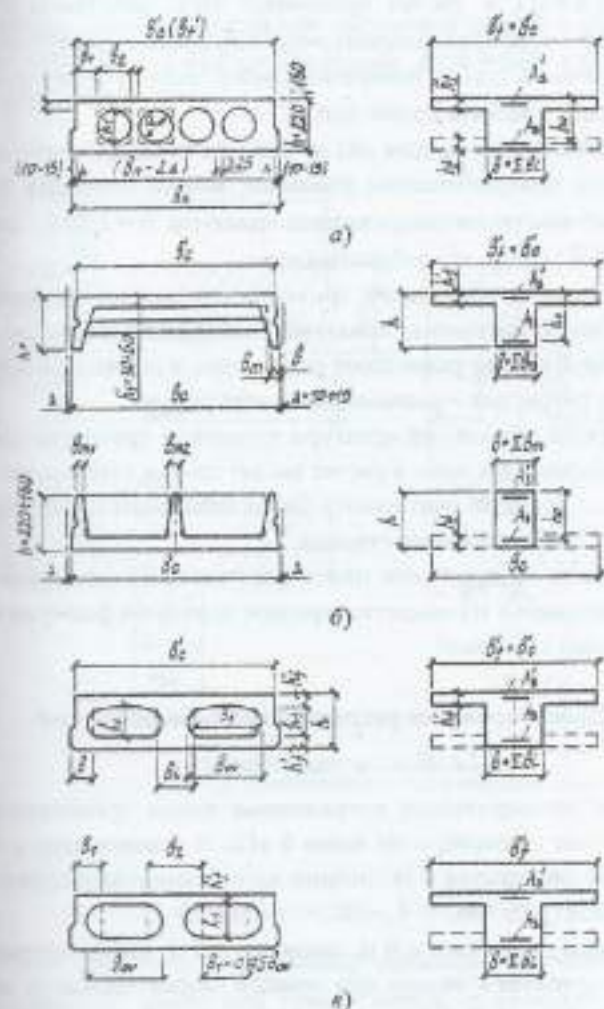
Заданные и расчетные сечения поперечного сечения плит перекрытий а – с круглыми пустотами; б – ребристых; в – с овальными пустотами
